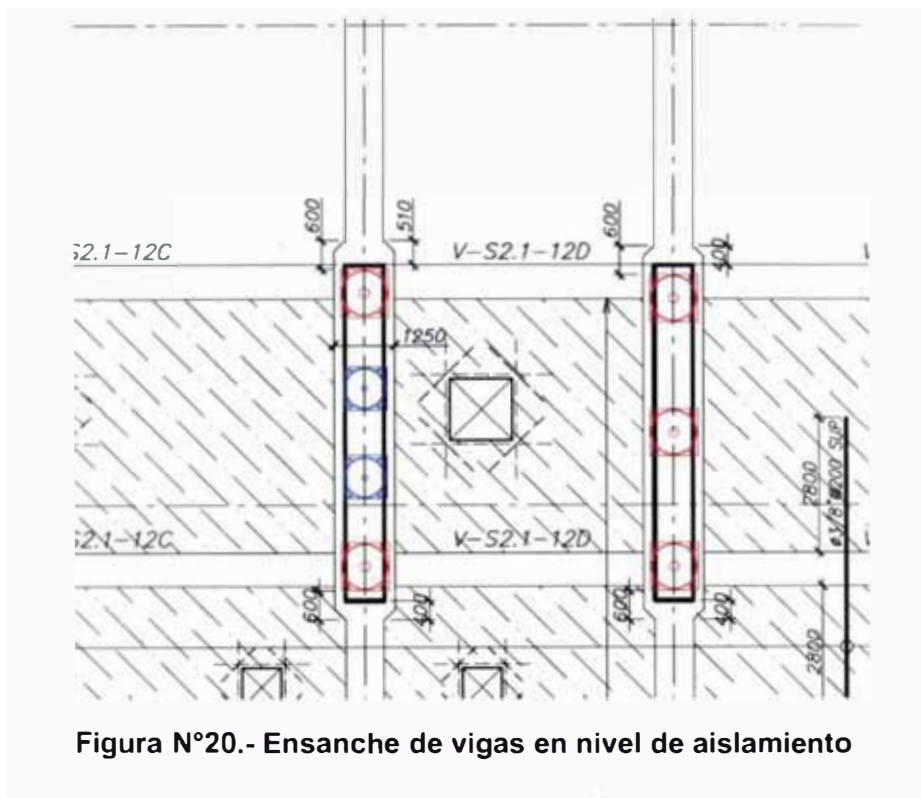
Ensanche de vigas en nivel de aislamiento
